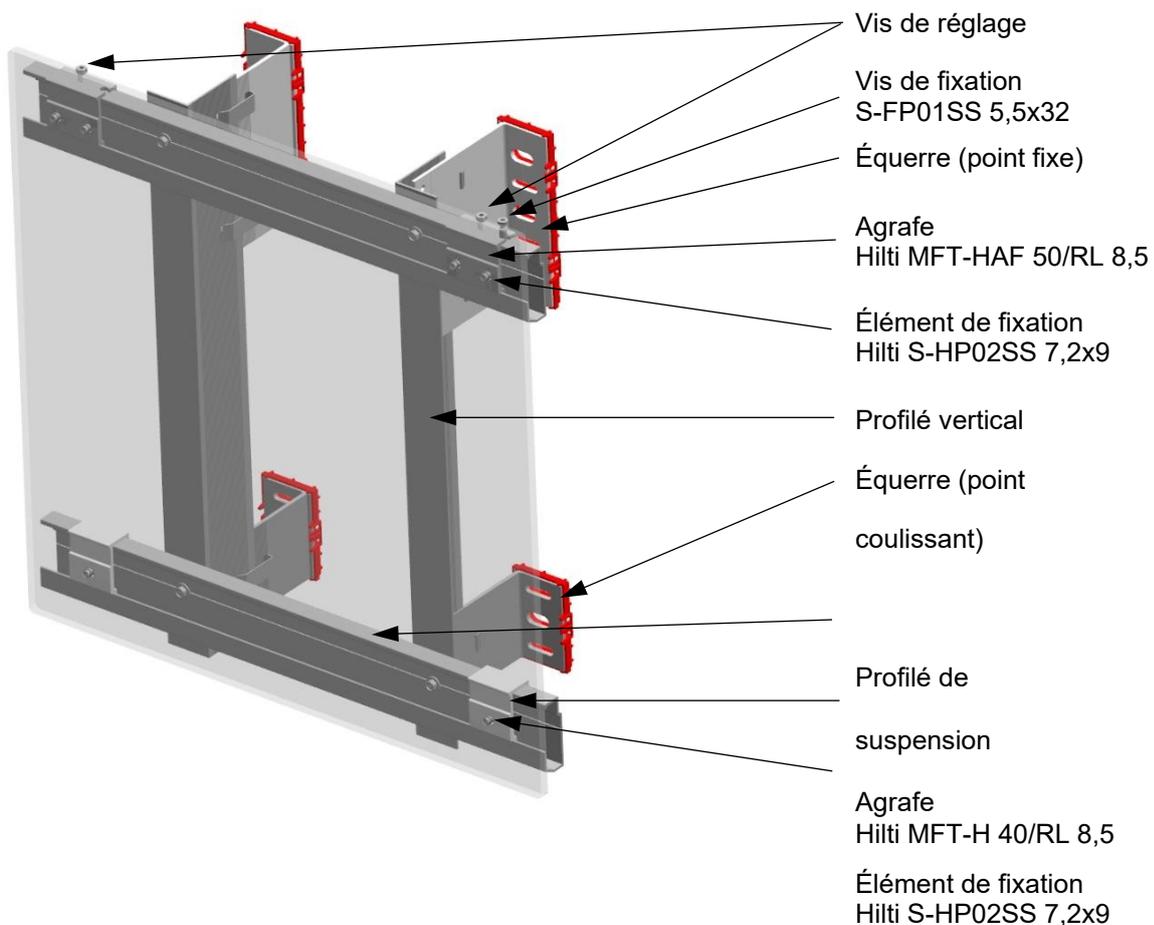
Exemple de fixation (panneau de façade sur une sous-structure)
